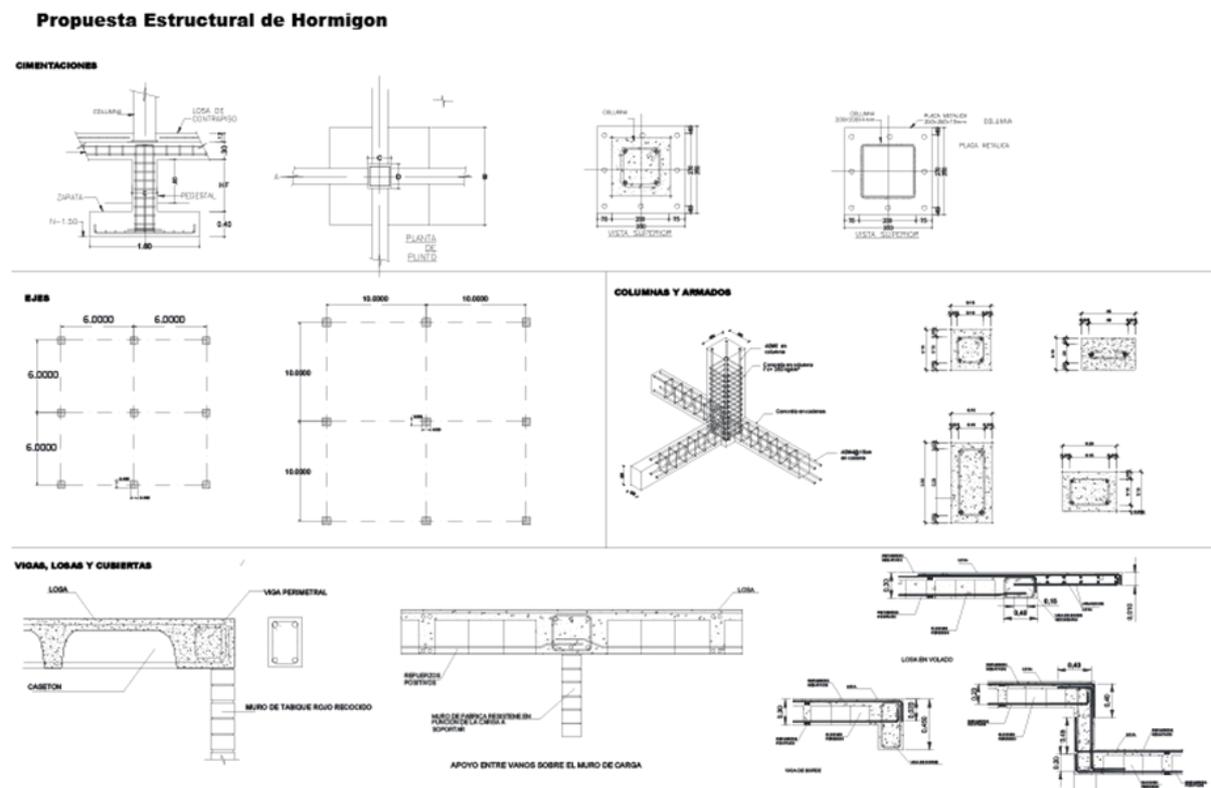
Propuesta estructural de hormigón . Elaboración grupal.
